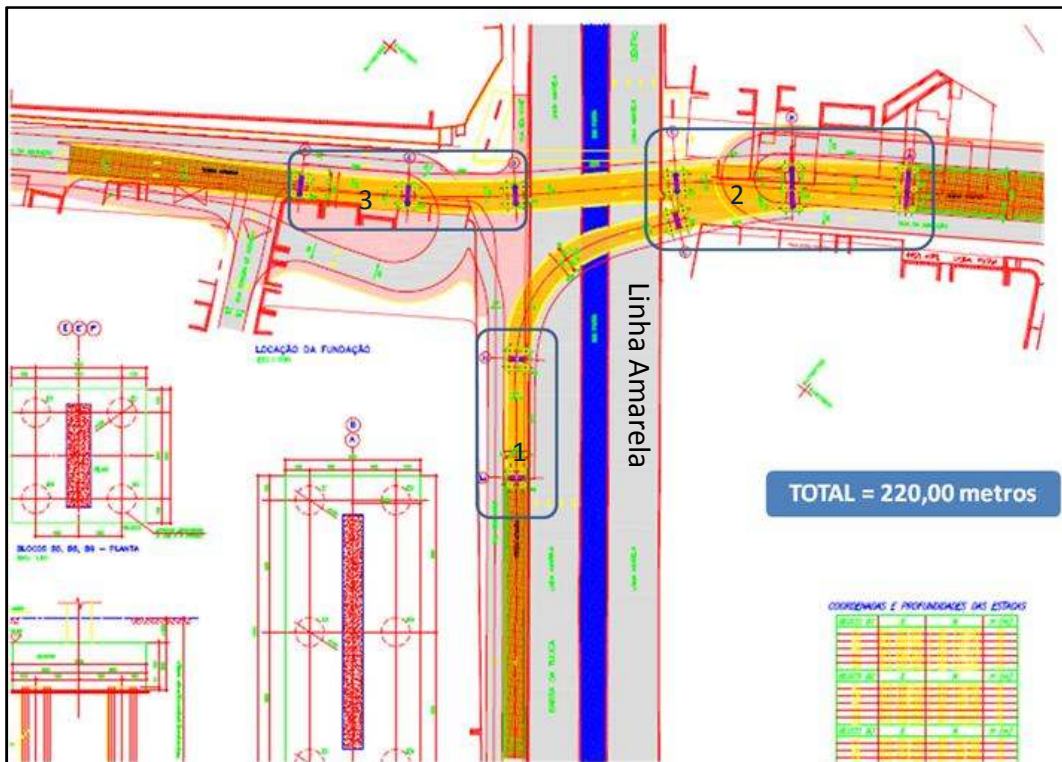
Trechos onde serão executadas vigas caixão com escoramento
